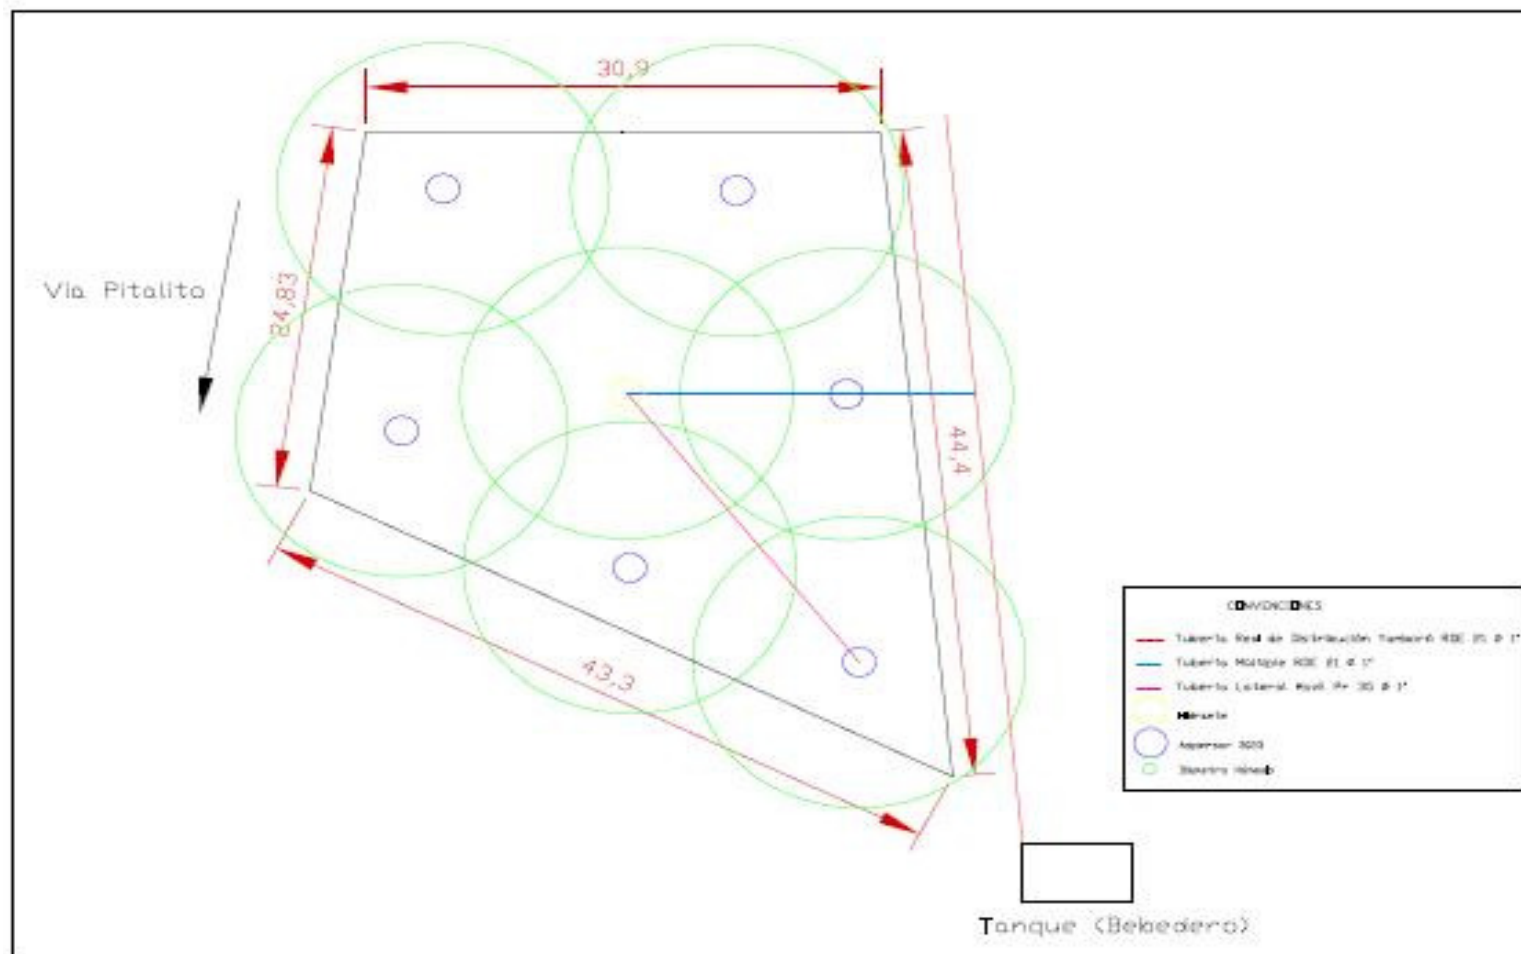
Vista en planta sistema de riego por aspersión, banco de proteínas
